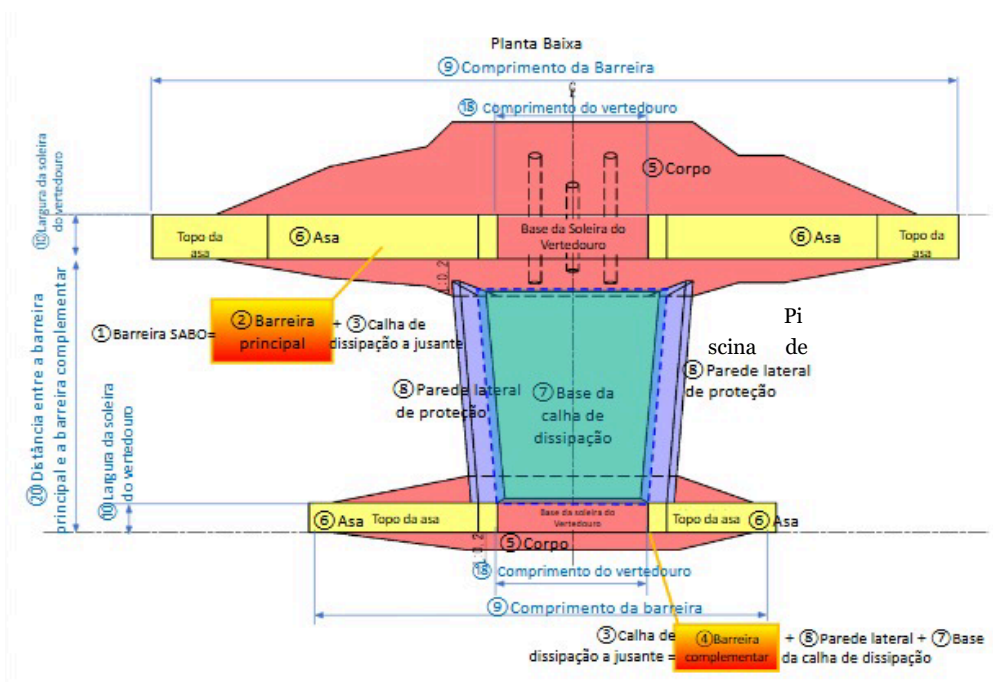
Planta baixa da barreira impermeável com piscina de absorção
